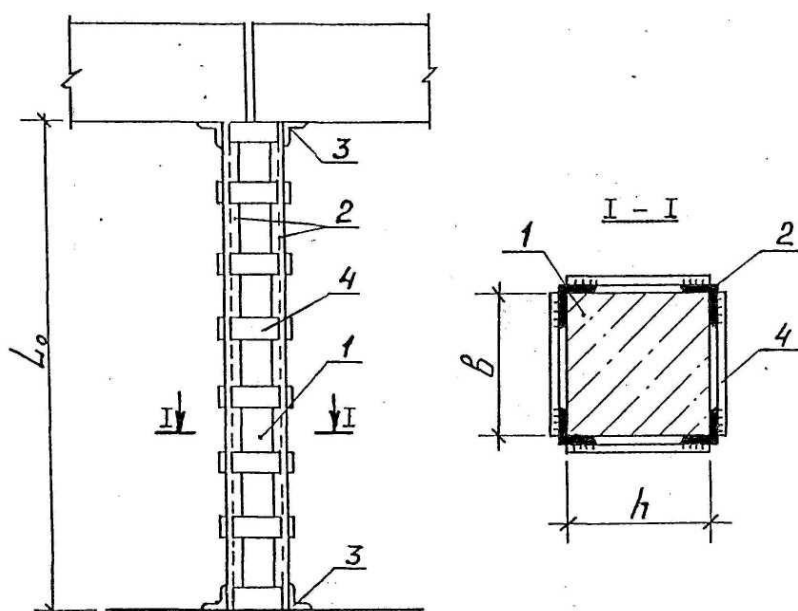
Усиление железобетонной колонны стальной обоймой из уголков
